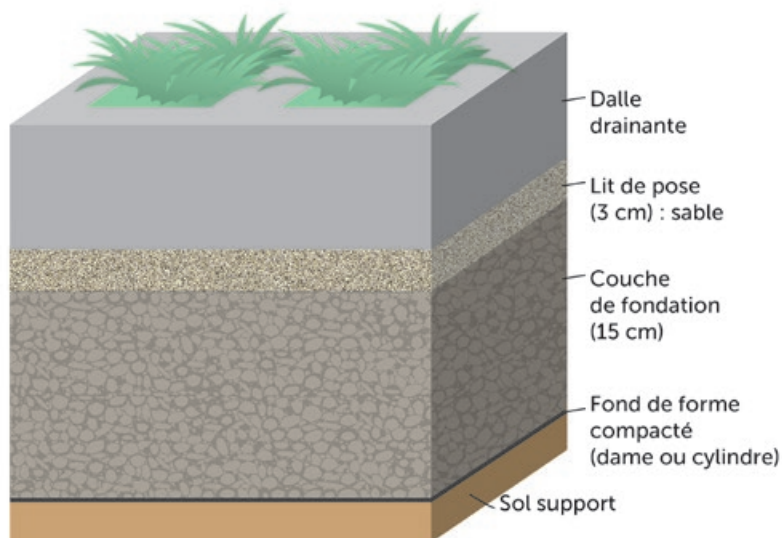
Coupe type d'une structure en dalles drainantes sous véhicules lourds en terrain porteur.
